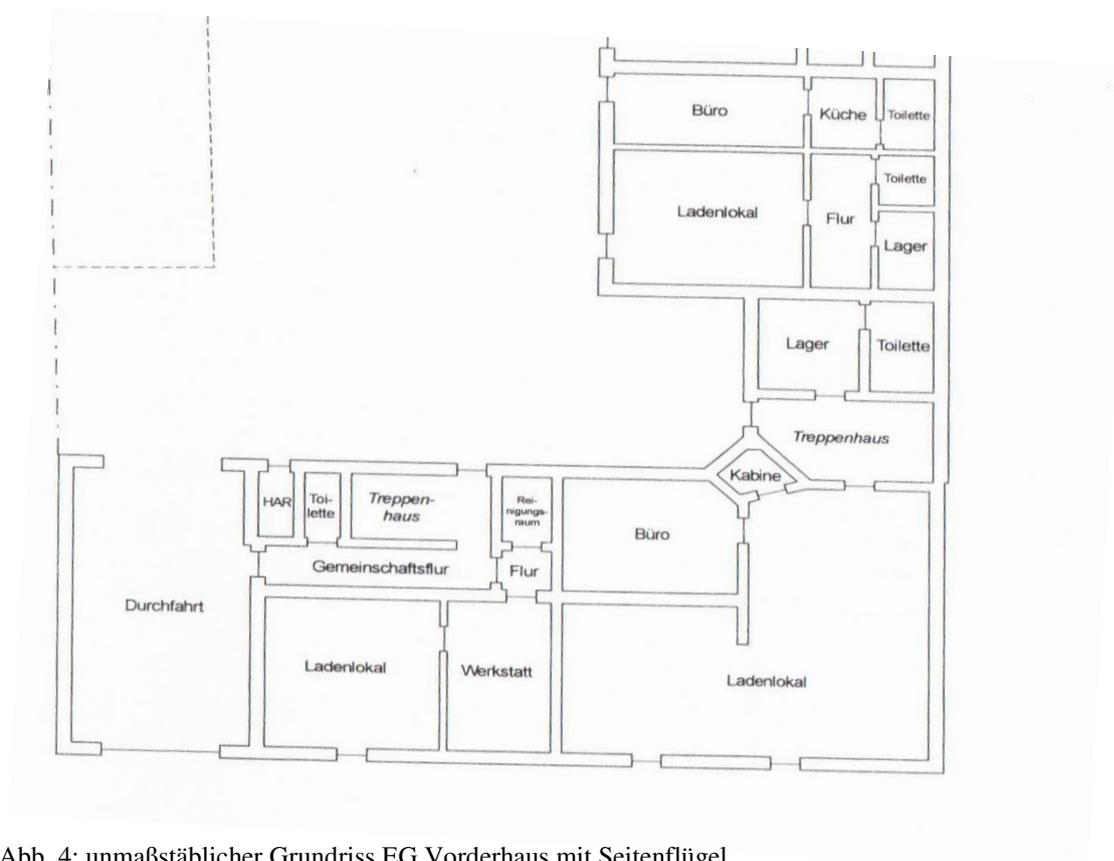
unmaßstäblicher Grundriss EG Vorderhaus mit Seitenflügel
